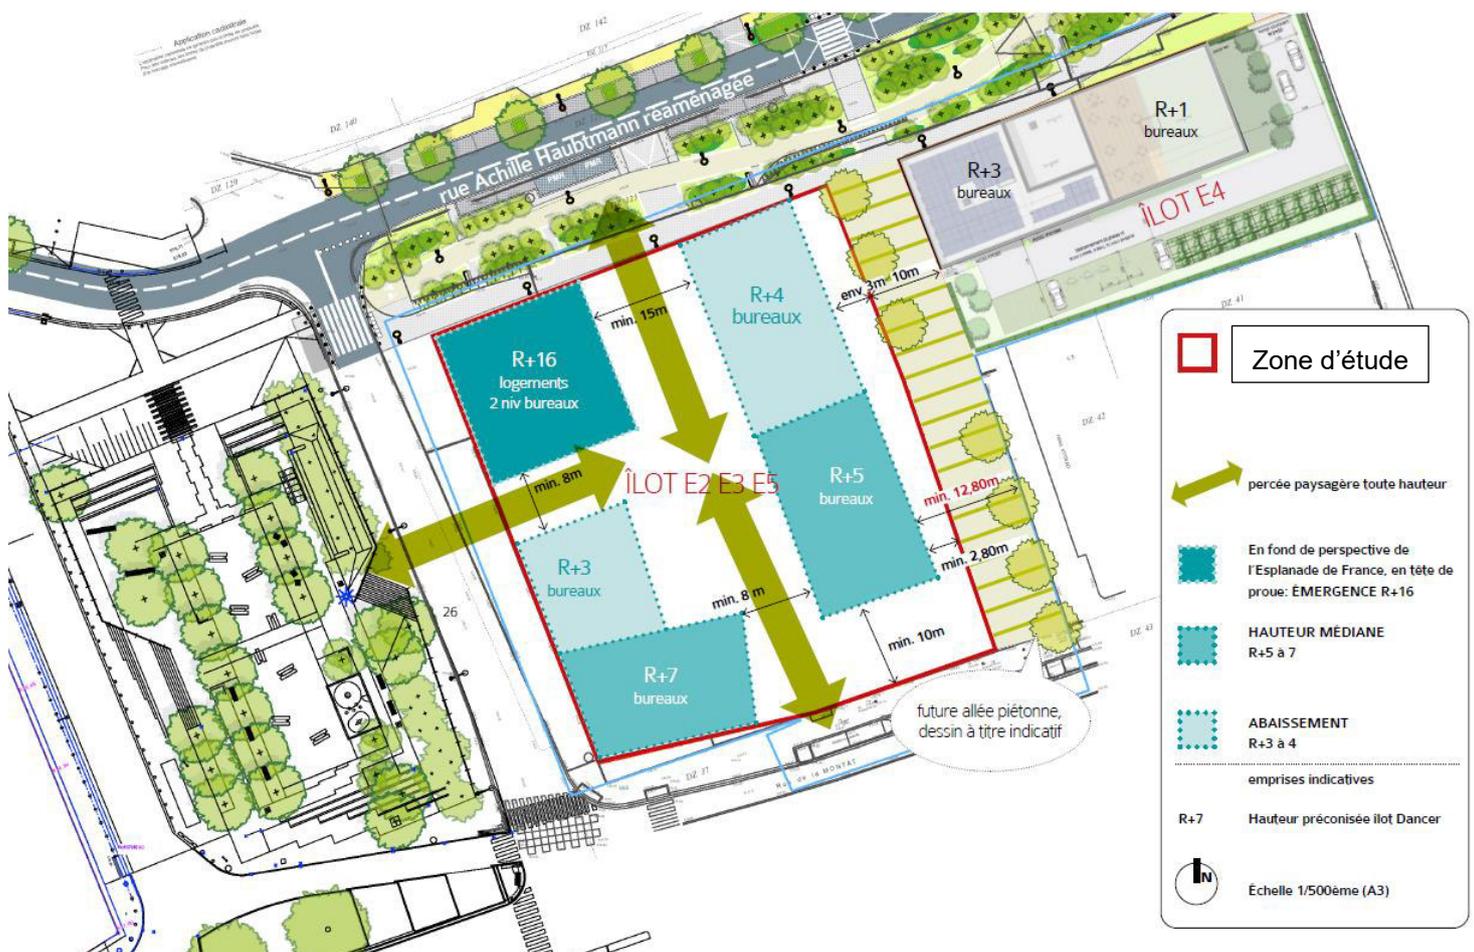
Organisation spatiale projetée et plan de masse du site (source : EPASE, avril 2022)
